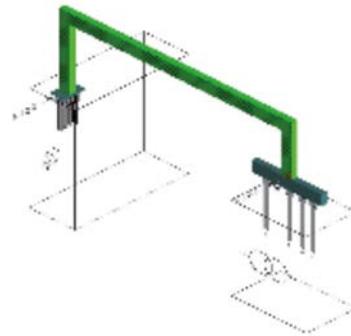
Collegamento di un quadro Power Center attraverso un condotto sbarre prefabbricato
